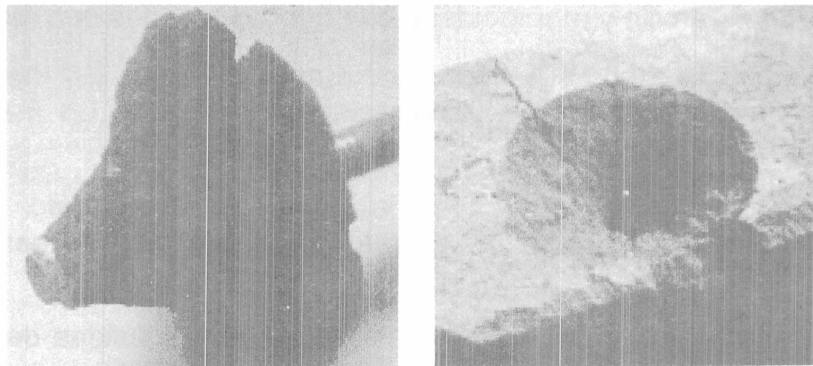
Falla típica de extracción de un fijador embebido en mampostería. La fuerza de extracción y el cono de mampostería formado son indicadores de la resistencia de la misma.
